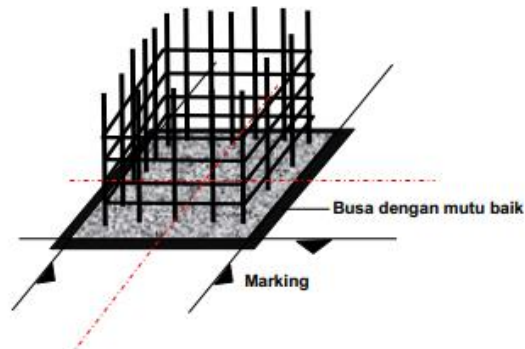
5 Pemasangan besi dan beton tahu pada kolom
